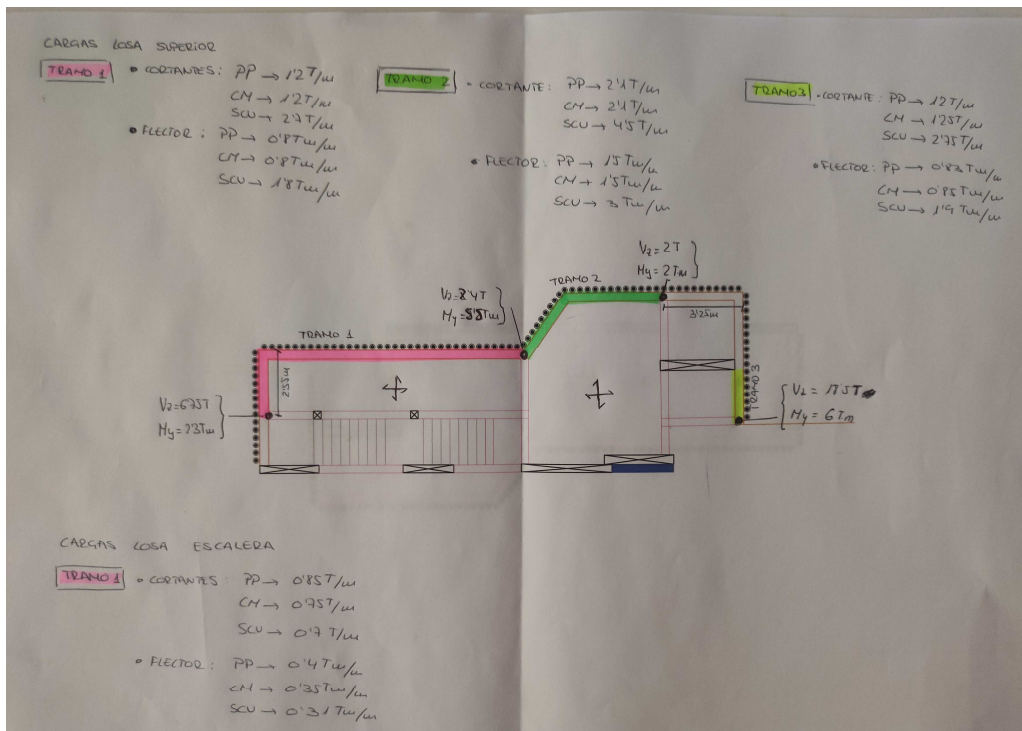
Acciones de la losa superior, de las escaleras y vigas a introducir sobre los muros (INGENIA)
